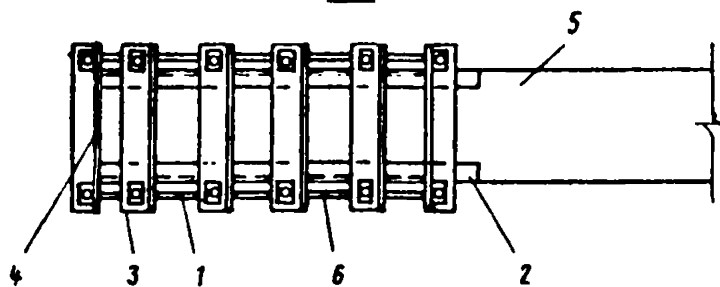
Схема усиления жесткого узла железобетонной рамы с помощью предварительно напряженных стержней
